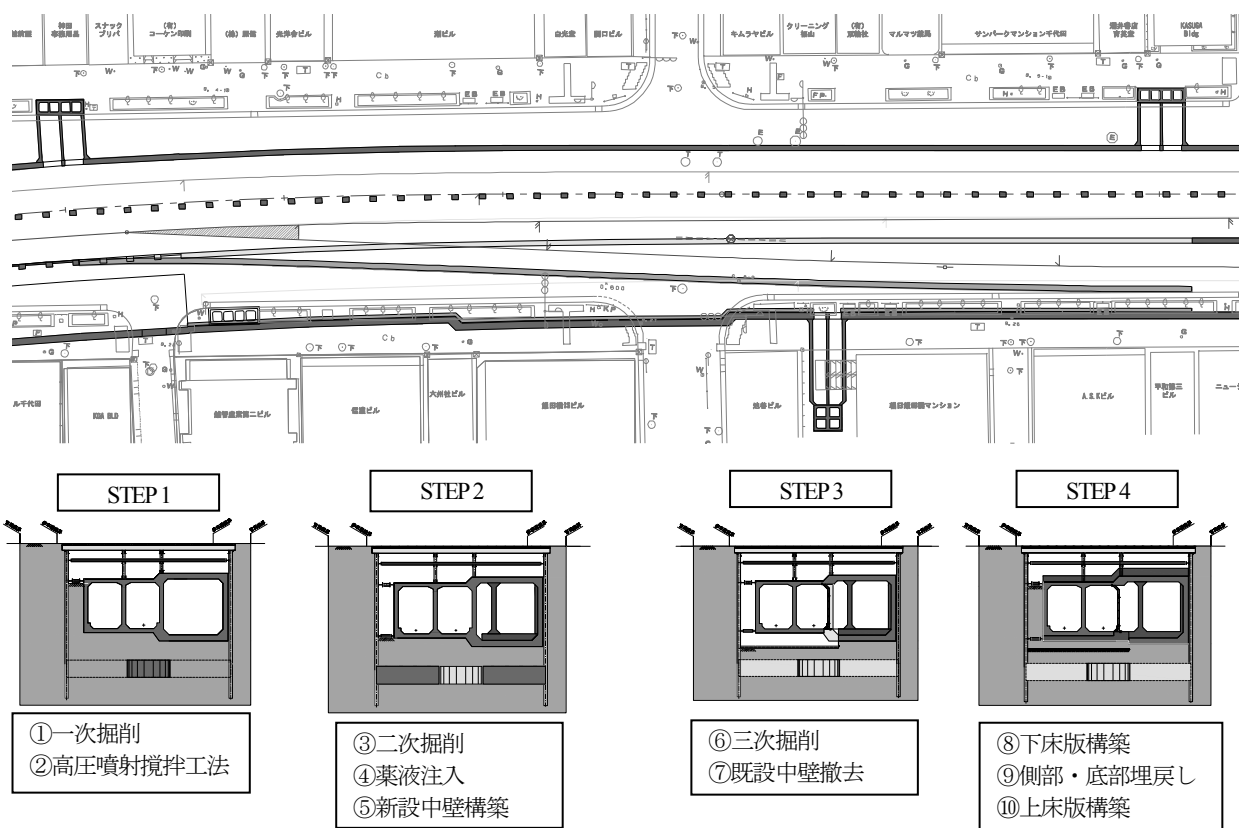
飯田橋工区新旧対照平面図及び施工ステップ
